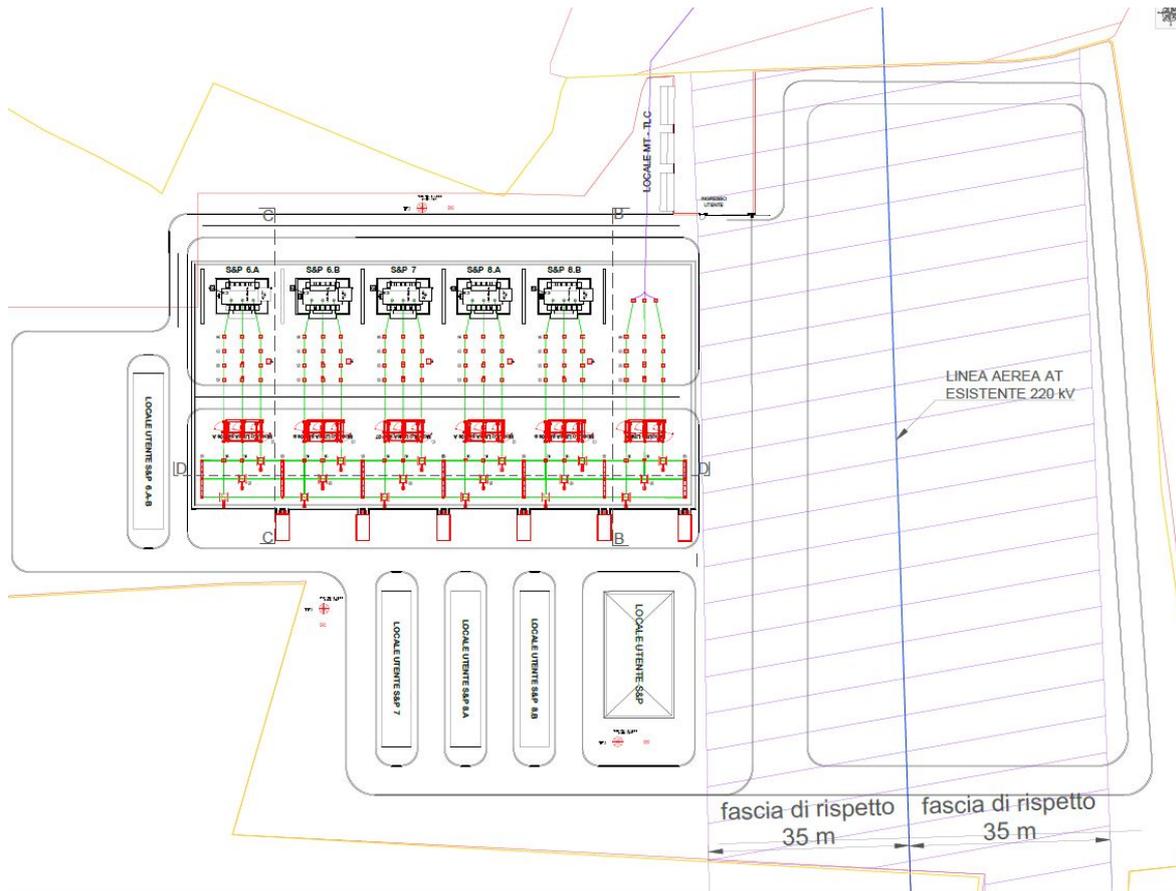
Pianta elettromeccanica generale – Stazione utente
